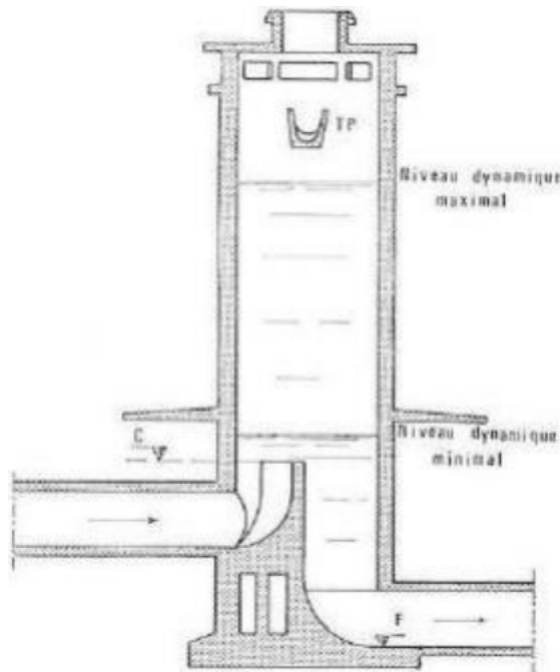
Vue en plan d'une cheminée d'équilibre
